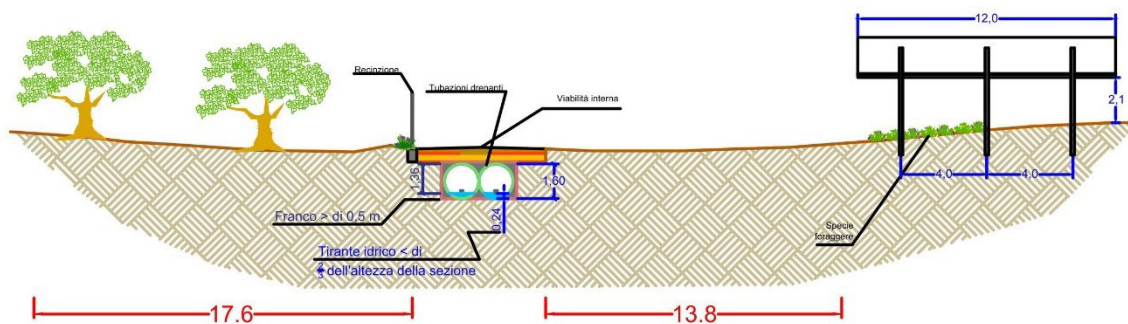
Attraversamento corso d'acqua localizzato all'interno dell'Area C con la viabilità interna di nuova realizzazione e indicazione posizione tubazioni drenanti a sezione circolare di nuova realizzazione – estratto dell'elaborato di progetto "Tav.34 Inquadramento su CTR ante e post operam su bacini idrografici"
